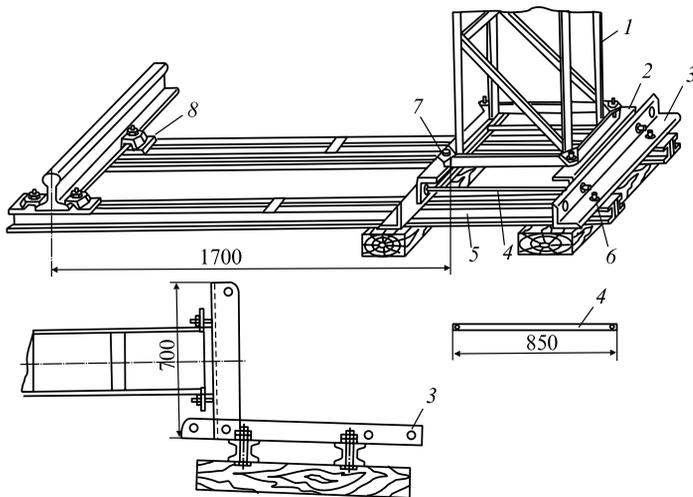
Конструкция «фундамента» с креплением за рельс: 1 — металлическая опора; 2 и 3 — верхний и нижний уголки; 4 — крепежный стержень; 5 — рама; 6 и 7 — рамный и опорный болты; 8 — подкладка
